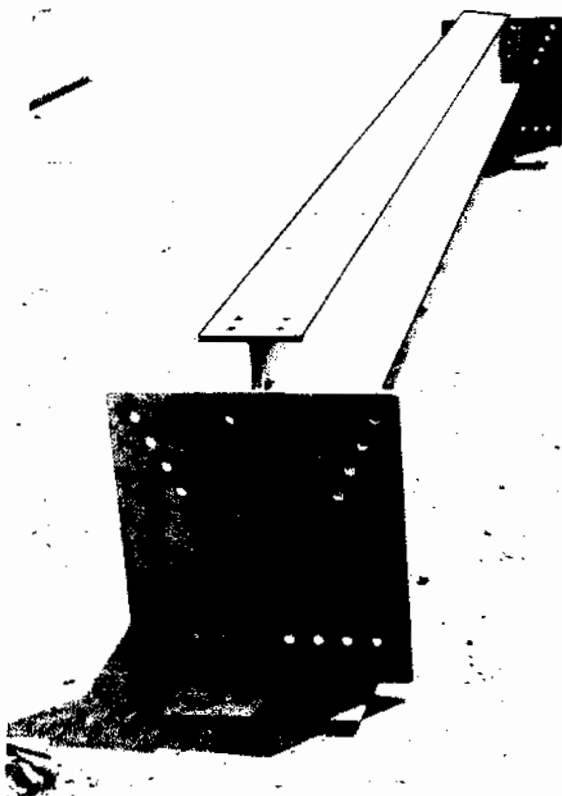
Viga transversal armada con platina inferior y contra viento
